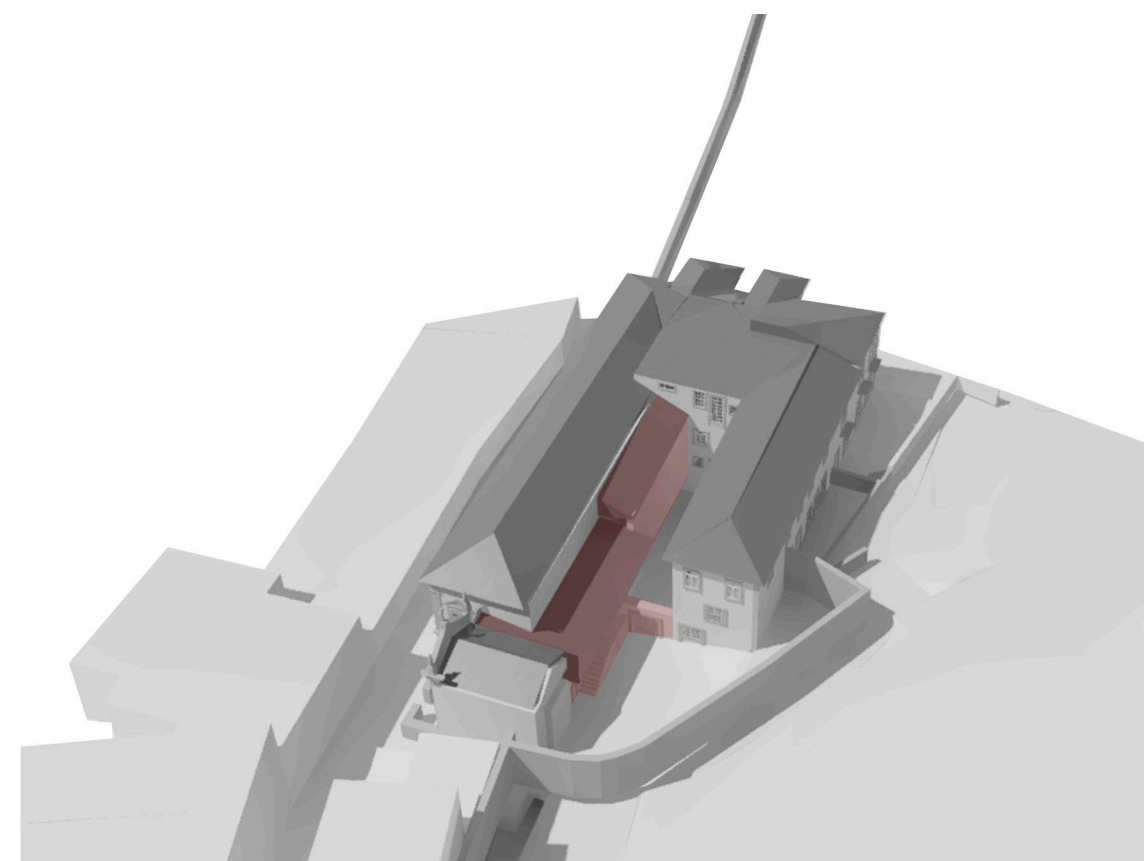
Modelo tridimensional da fase 4 - Indicação das novas construções
